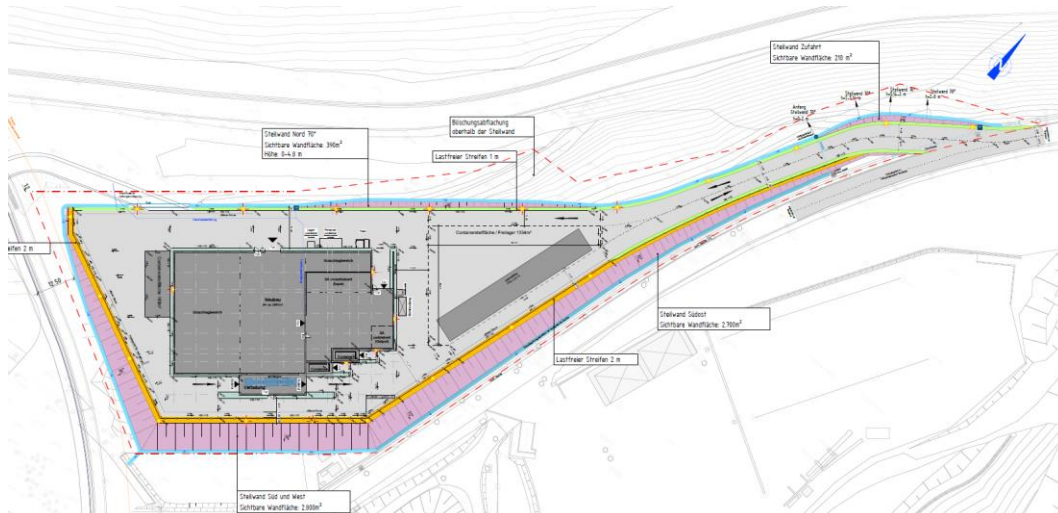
Ausschnitt Plan G 04 (Quelle SCHIRMER UT)
